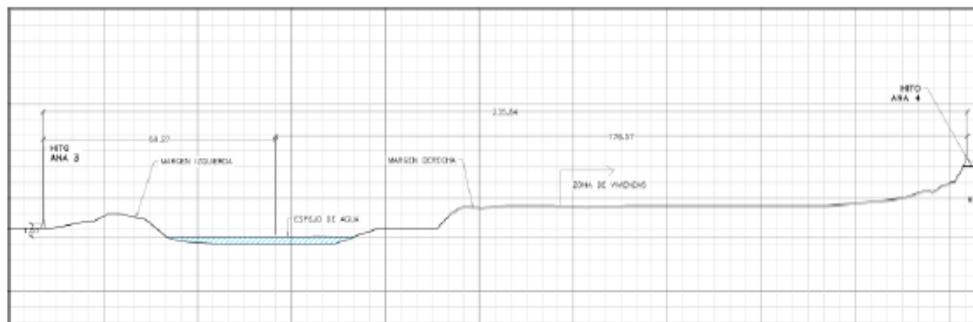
Rotulado del plano de secciones presentado en formato editable, extensión dwg
